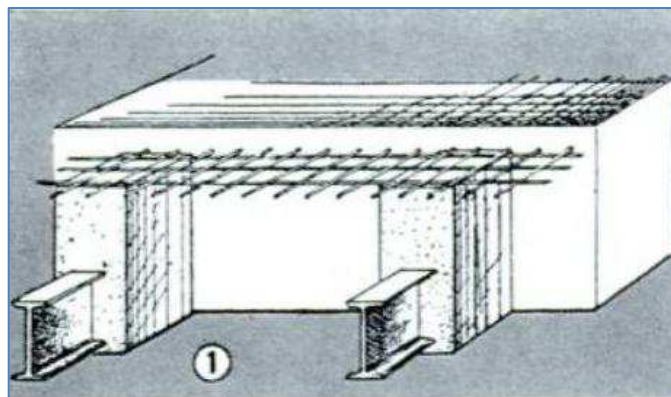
Realización de las primeras macetas de hormigón
